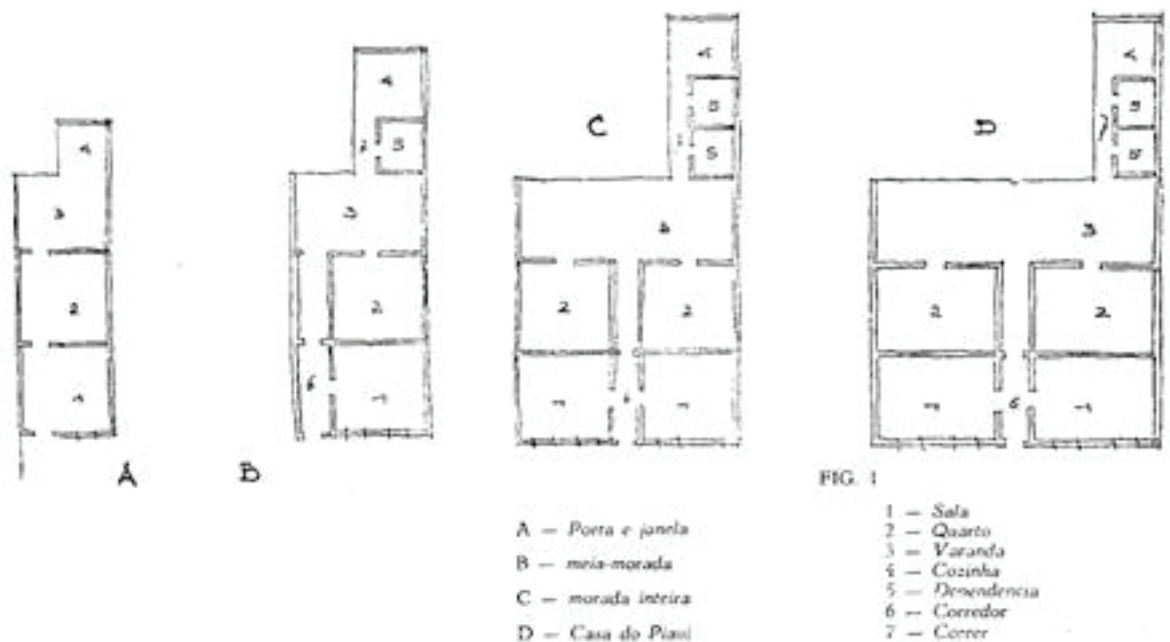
Tipos de plantas da casa piauiense (por Paulo Thedim Barreto).
